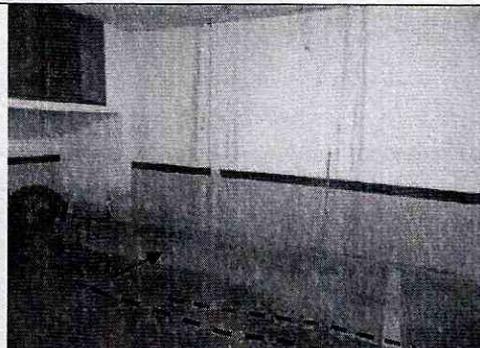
Resanes y reparación de grietas de tendencia horizontal de abertura cercana a 0.3 cm en muros de cerramiento del primer nivel de la vivienda Carrera 8 No. 108A-69.
